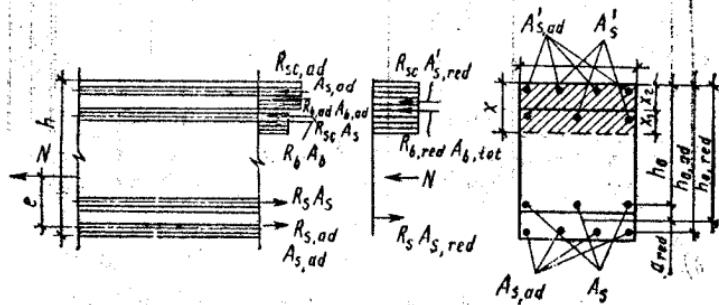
К примеру расчета усиленного изгибающего элемента
